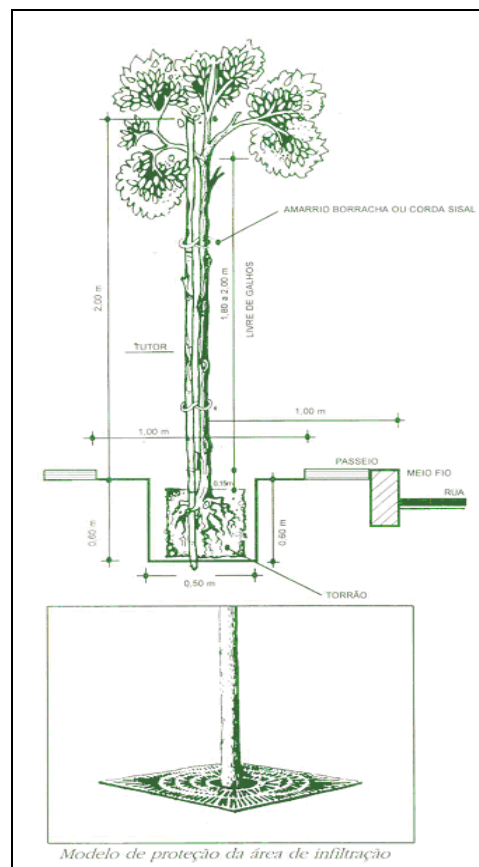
Dimensões da cova de plantio e largura de área de infiltração
